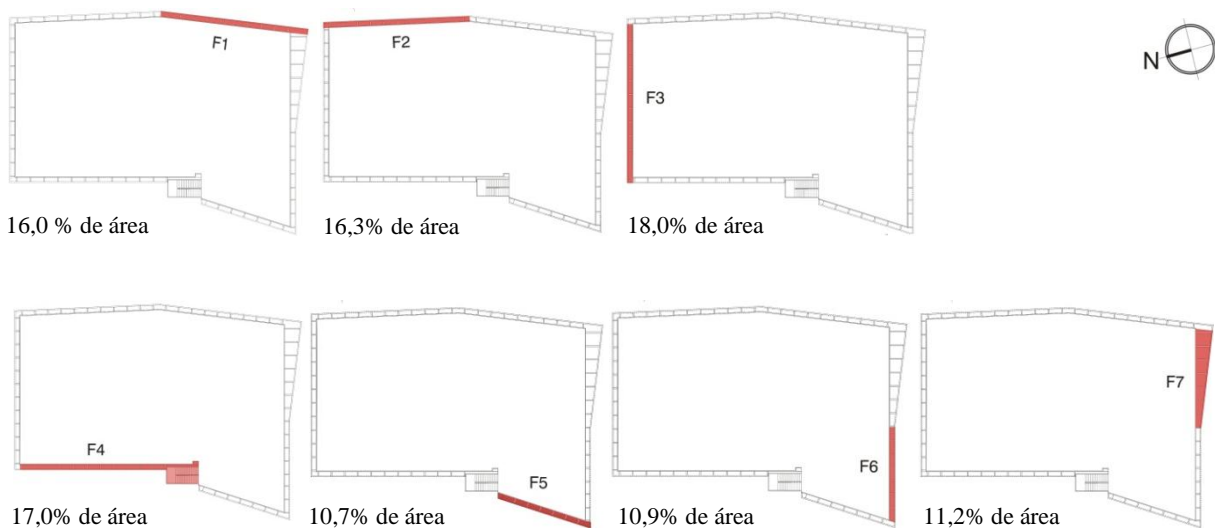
Aporte al área total de fachadas de cada una de las fachadas.
